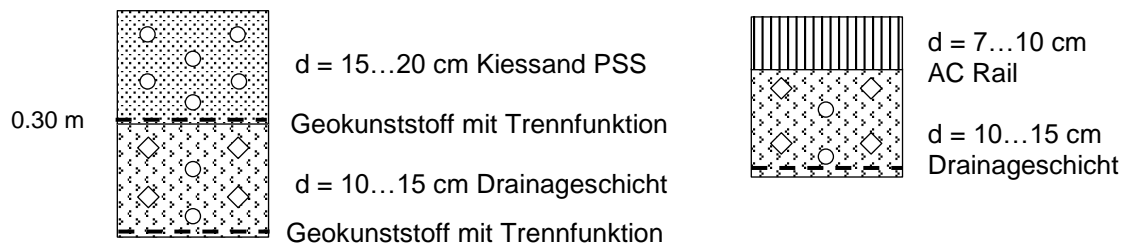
Aufbauten Sandwichprofile mit Kiessand PSS und AC Rail
